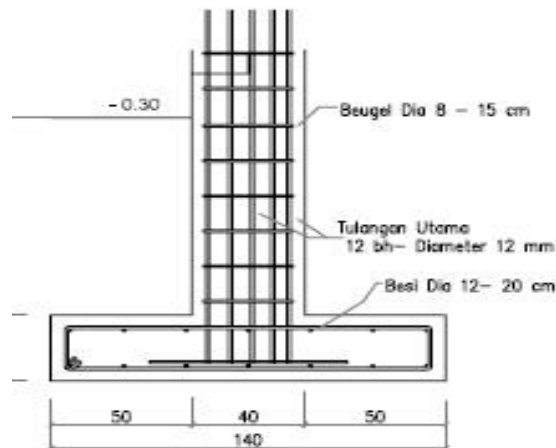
Strip Foundations* (Fondasi Menerus)
